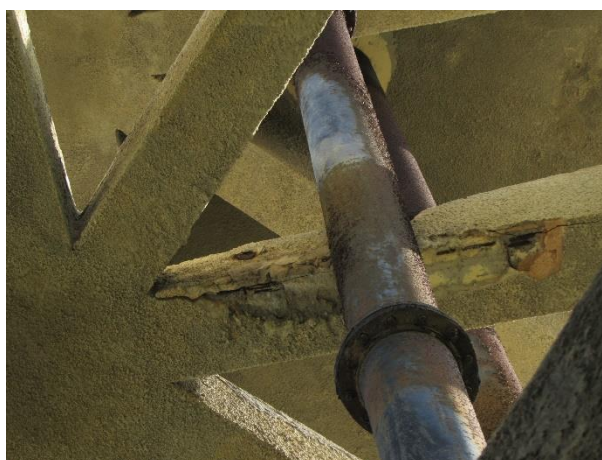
Deslocamento do concreto com corrosão da armadura na viga interna de travamento.
